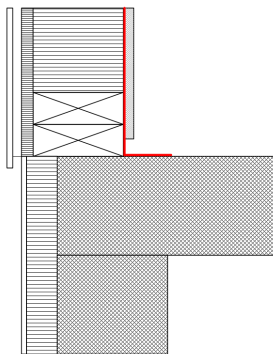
Esempio di un raccordo tra pavimento e parete esterna
